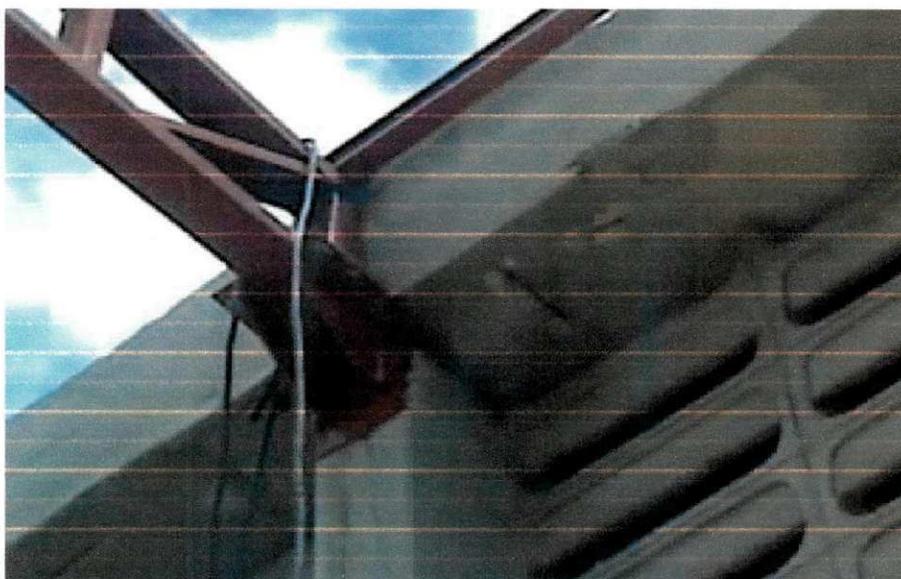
Conexão da viga treliçada com pilar de concreto São Braz –Cabedelo-Pb
